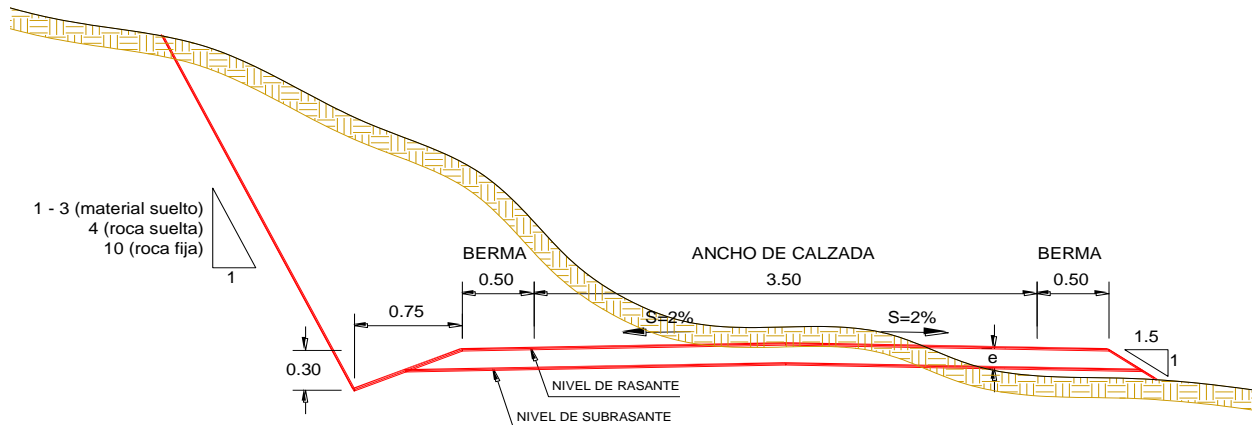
SECCION TIPICA – ANCHO DE BERMAS
